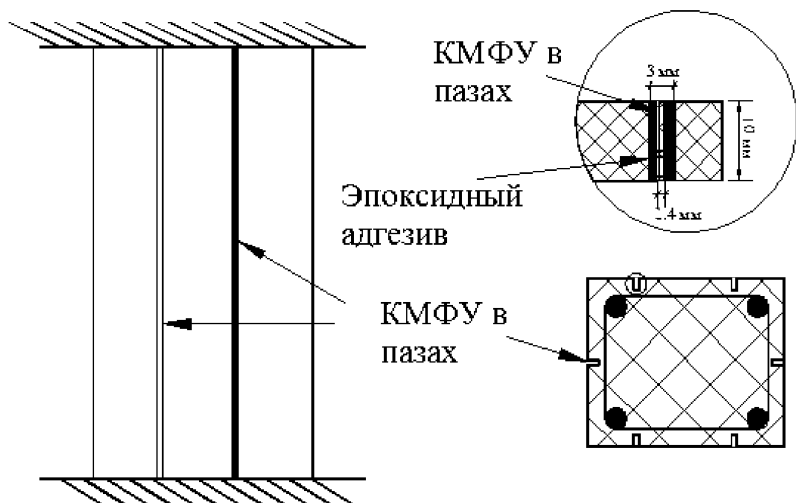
Усиление железобетонных колонн установкой КМФУ в пазы
